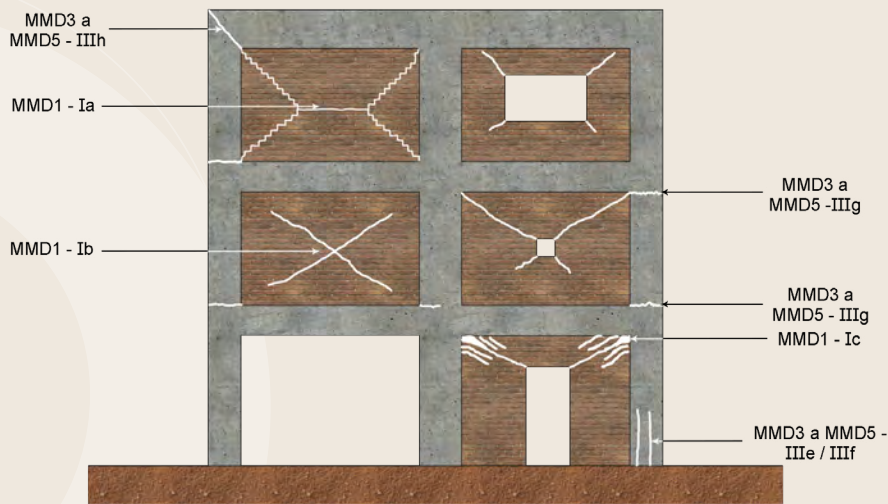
Modos de comportamiento en una construcción idealizada de marcos de concreto con muros diafragma. Fuente: elaboración propia.
